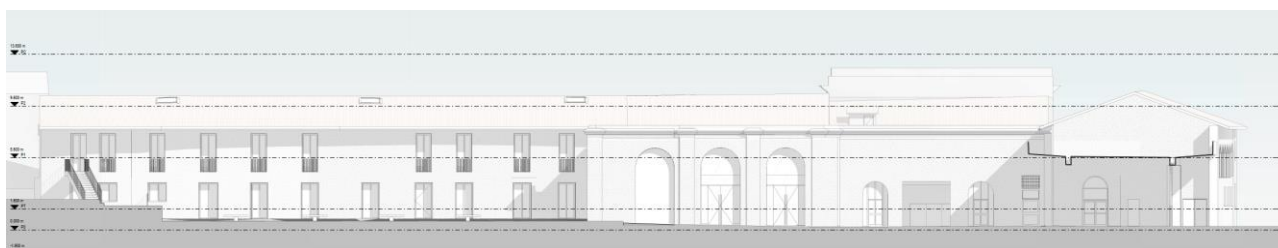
Prospetto interno con la realizzazione delle nuove aperture e del nuovo ingresso carrabile (edificio C1, C2)
